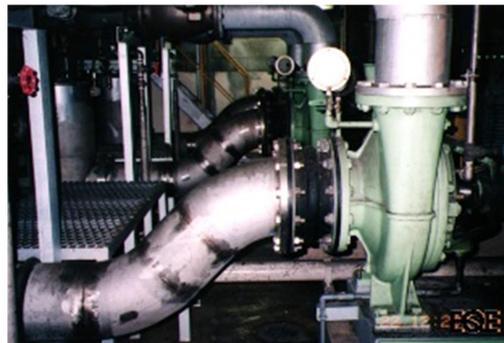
Подключение трубопровода к оборудованию через компенсатор
